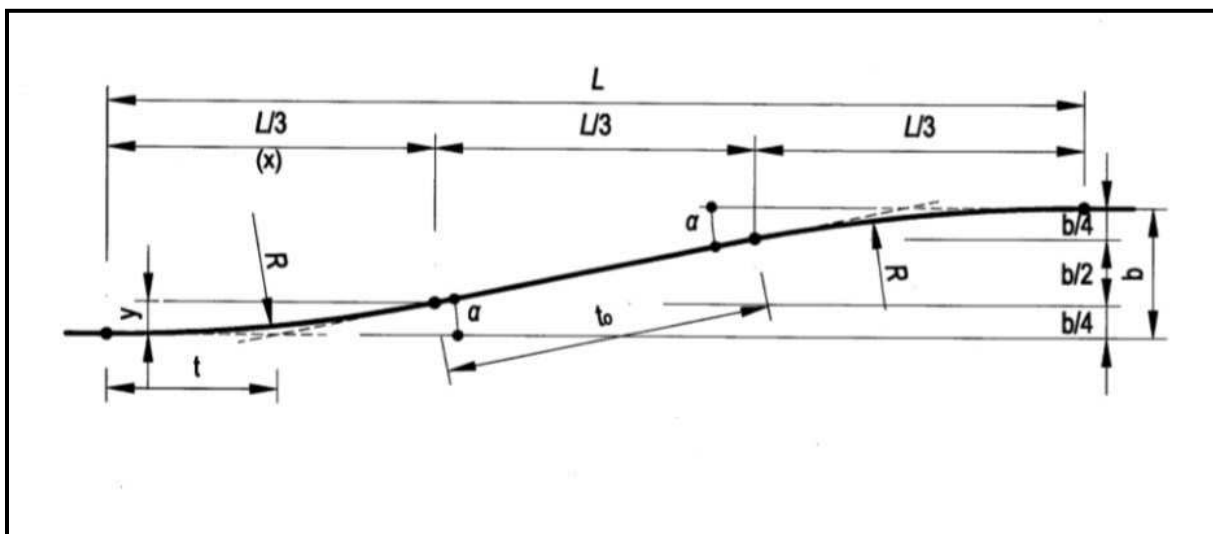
Varianta 3 – schéma odbočovacího pruhu vpravo ČSN 73 6102 ED.2. [9]
